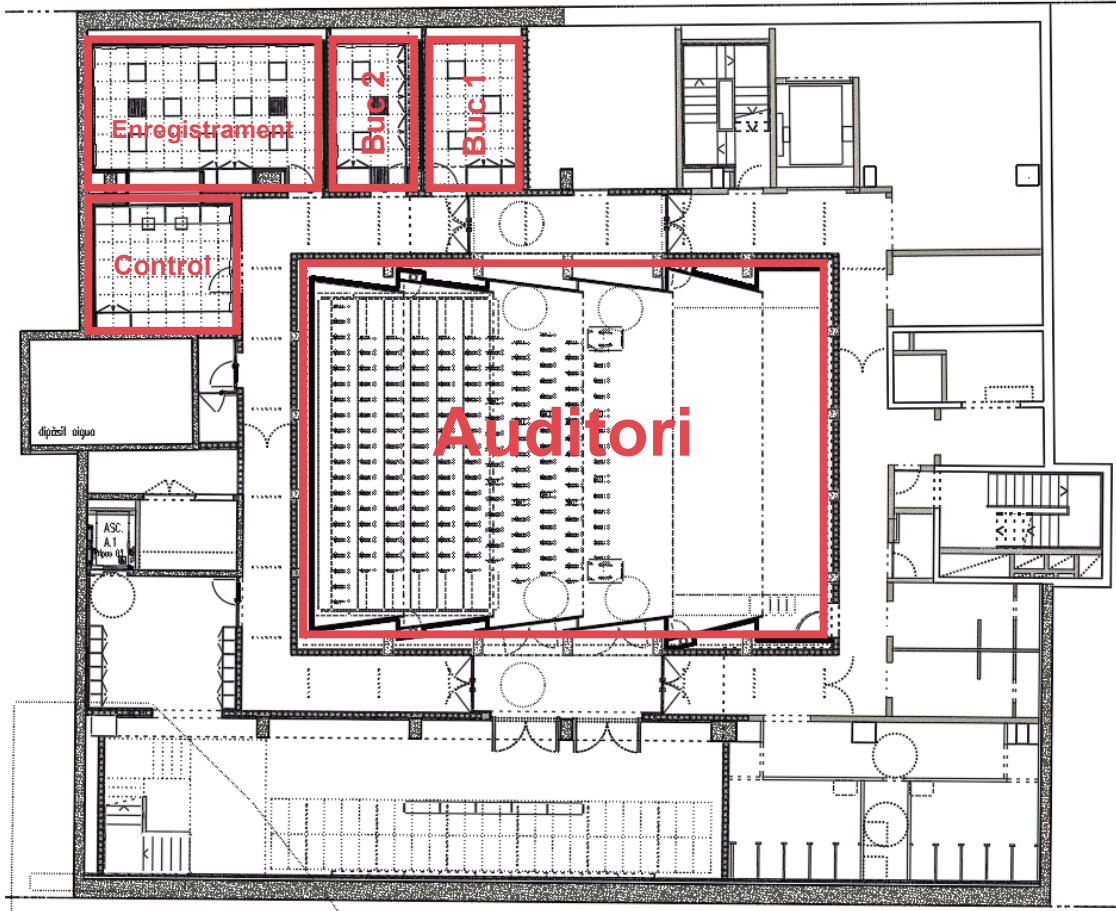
Ubicació de l'auditori i dels bucs d'assaig a la planta soterrani.
